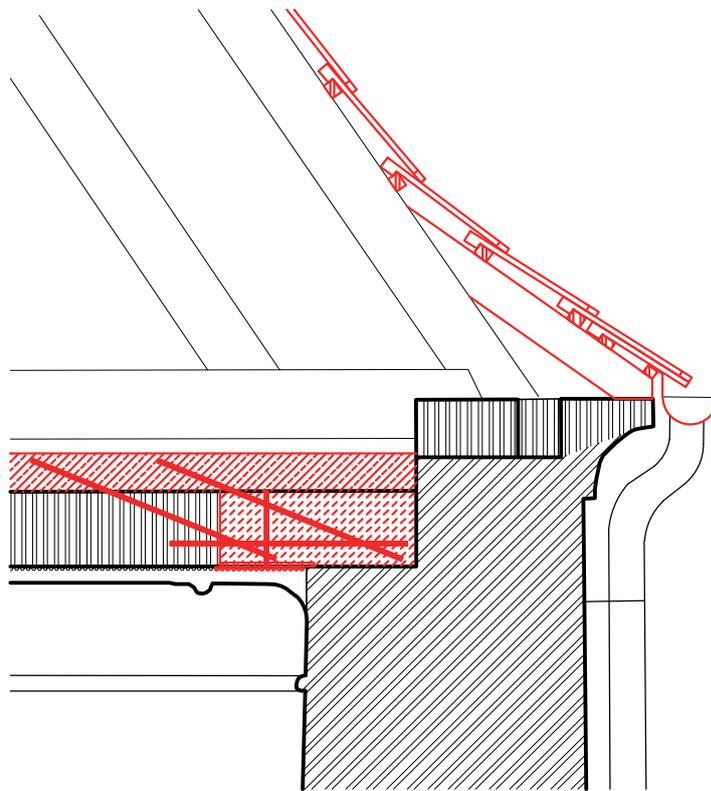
Vorschlag 2 zur Sanierung der Decke mit Polymerbeton und bewehrtem Aufbeton, Schnitt.
